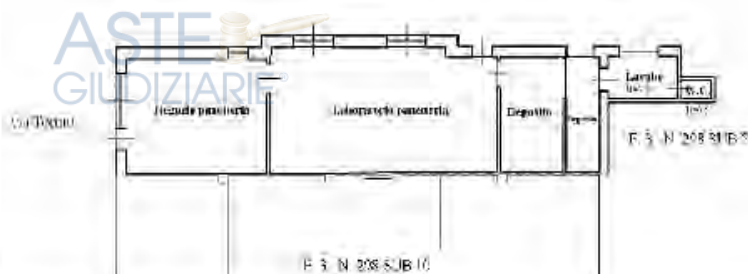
Planimetria catastale agli atti sub.9 part.298 fg.3 – piano terra (Pratica CN0259359 del 21/11/2006)
